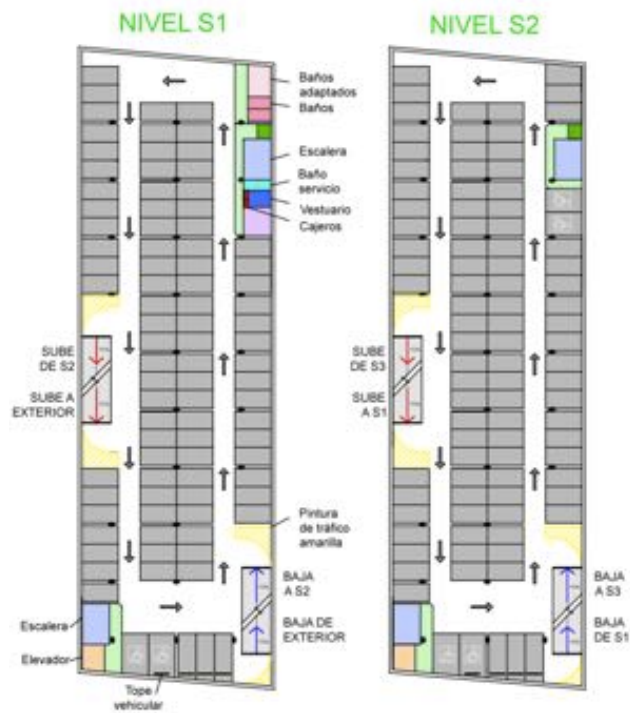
Alternativa 1 – Ubicación 1 y 2 Plantas
